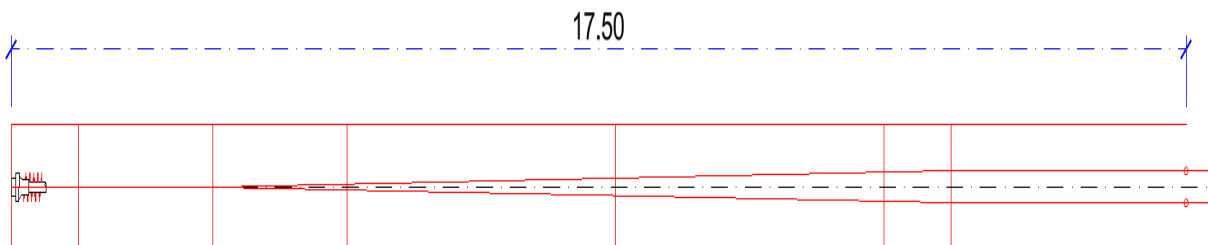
trajectoire des câbles en plan dans une demi-poutre
